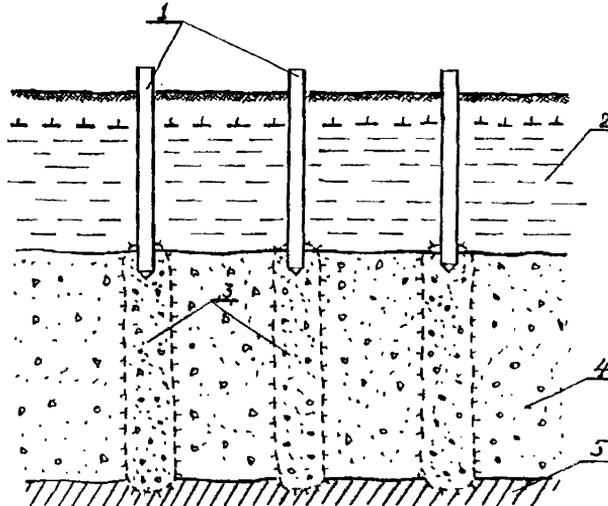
Схема устройства основания при опирании свай-стоек на локально оттаявшие зоны грунта:
